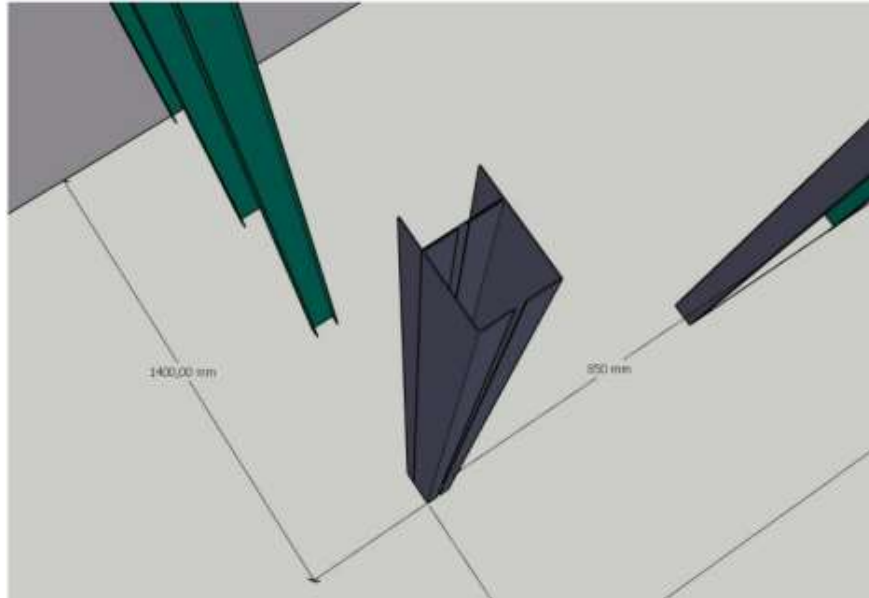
Detalhe do " pilar" do vértice, constituído por 3 montantes reforçados
